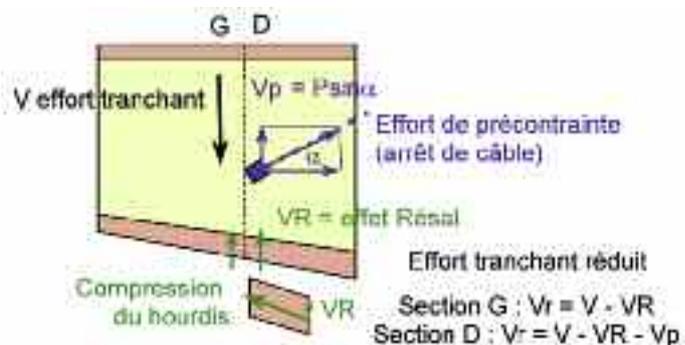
principe de calcul de l'effort tranchant au droit d'un arrêt de câbles
